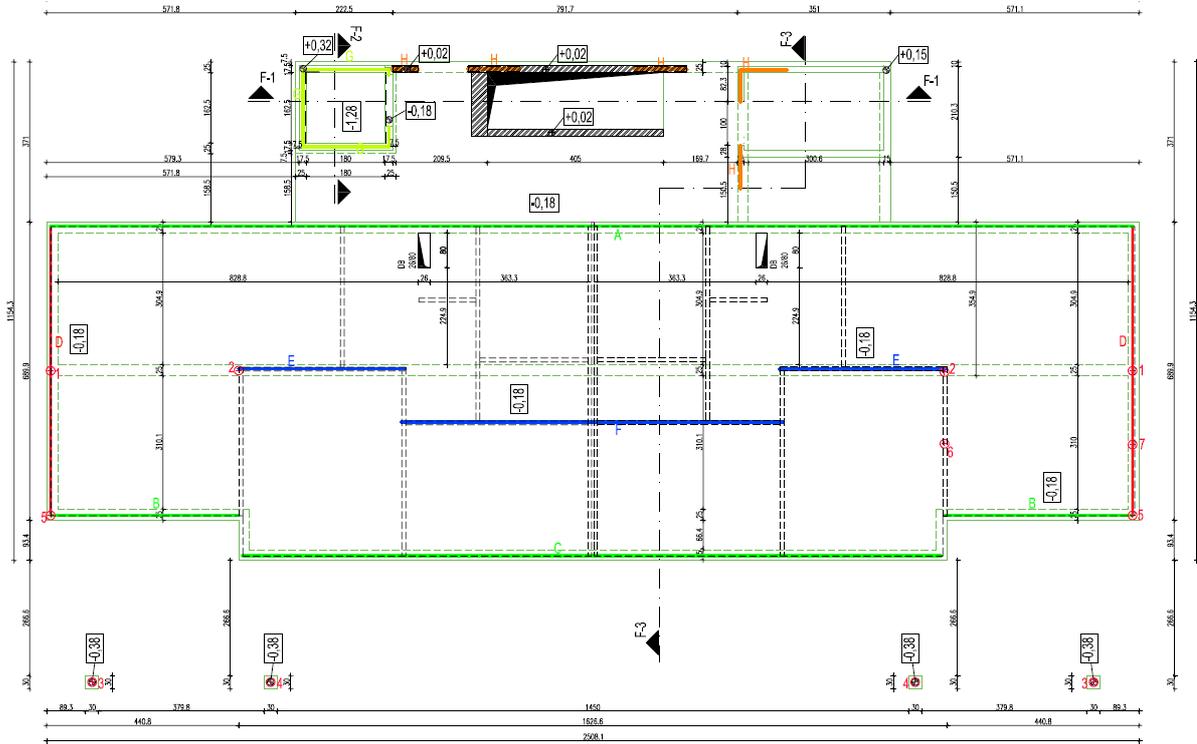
Grundriss des Kellers aus Stahlbeton
